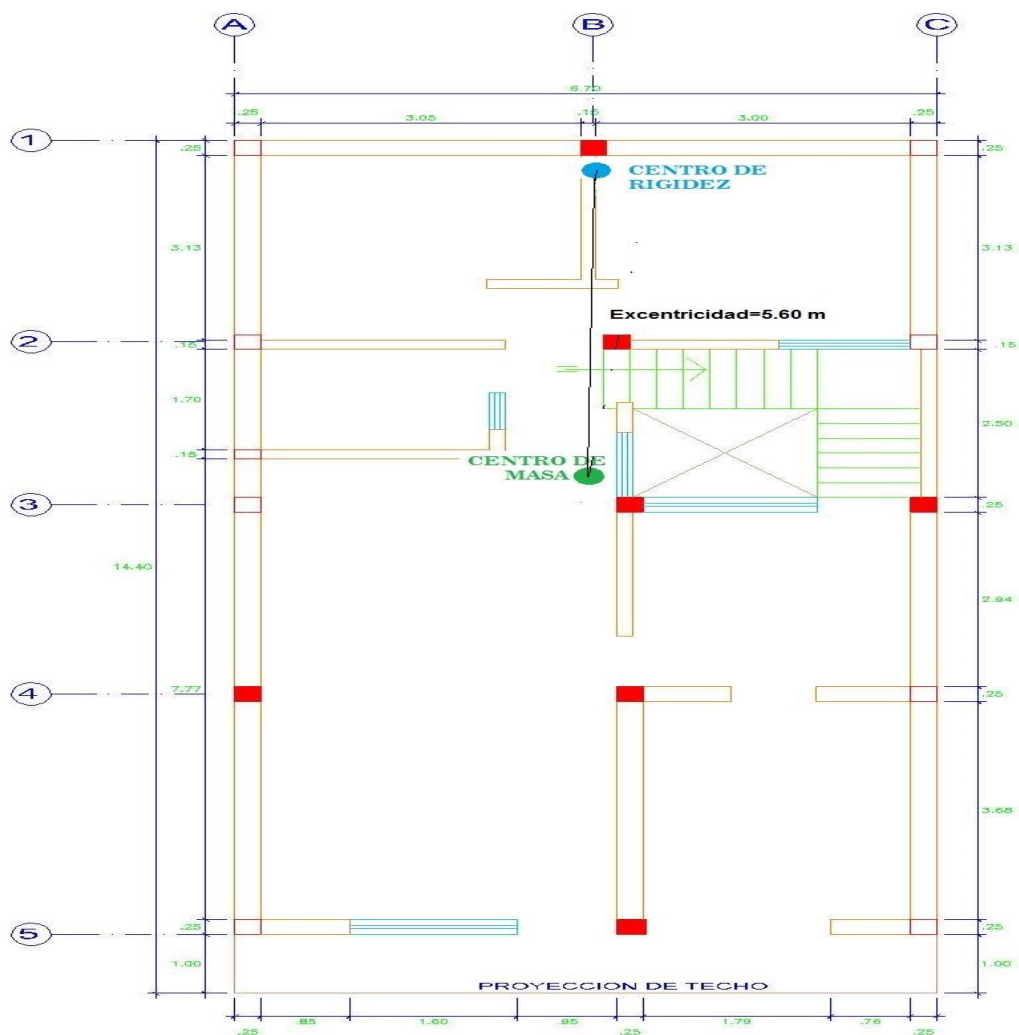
Ubicación del centro de masa y centro de rigidez en el plano de vista en planta del primer piso (Fuente: Elaboración propia)
